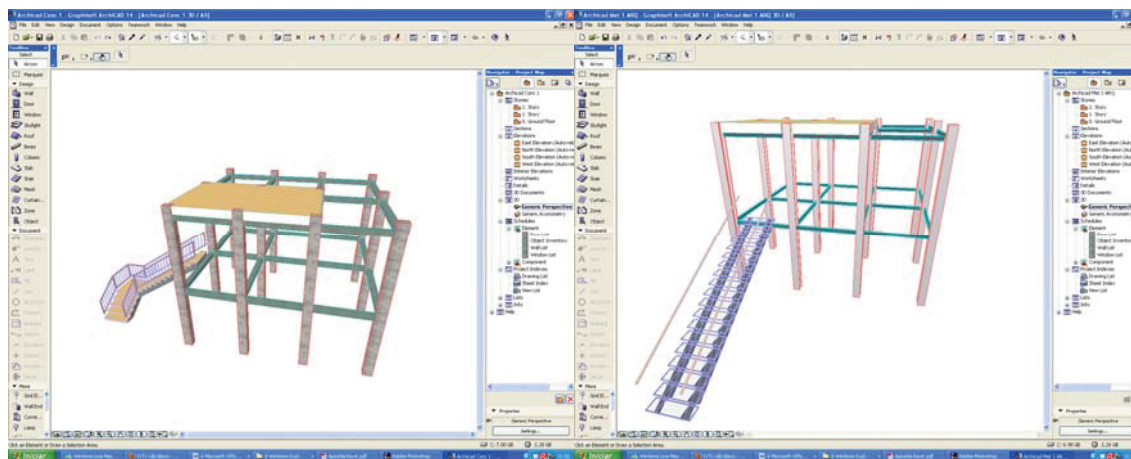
Modelagem estrutural no software ArchiCAD 14 (concreto e metálica)
